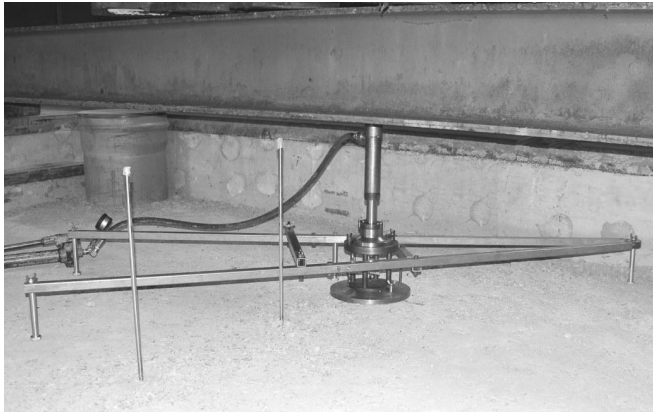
Exécution de l'essai de plaque standard sur les fondations
